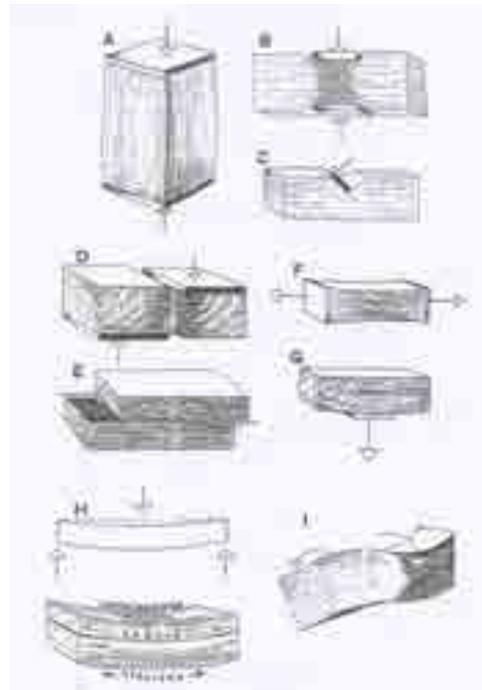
Sollecitazioni rispetto alla diversa orientazione della fibra
